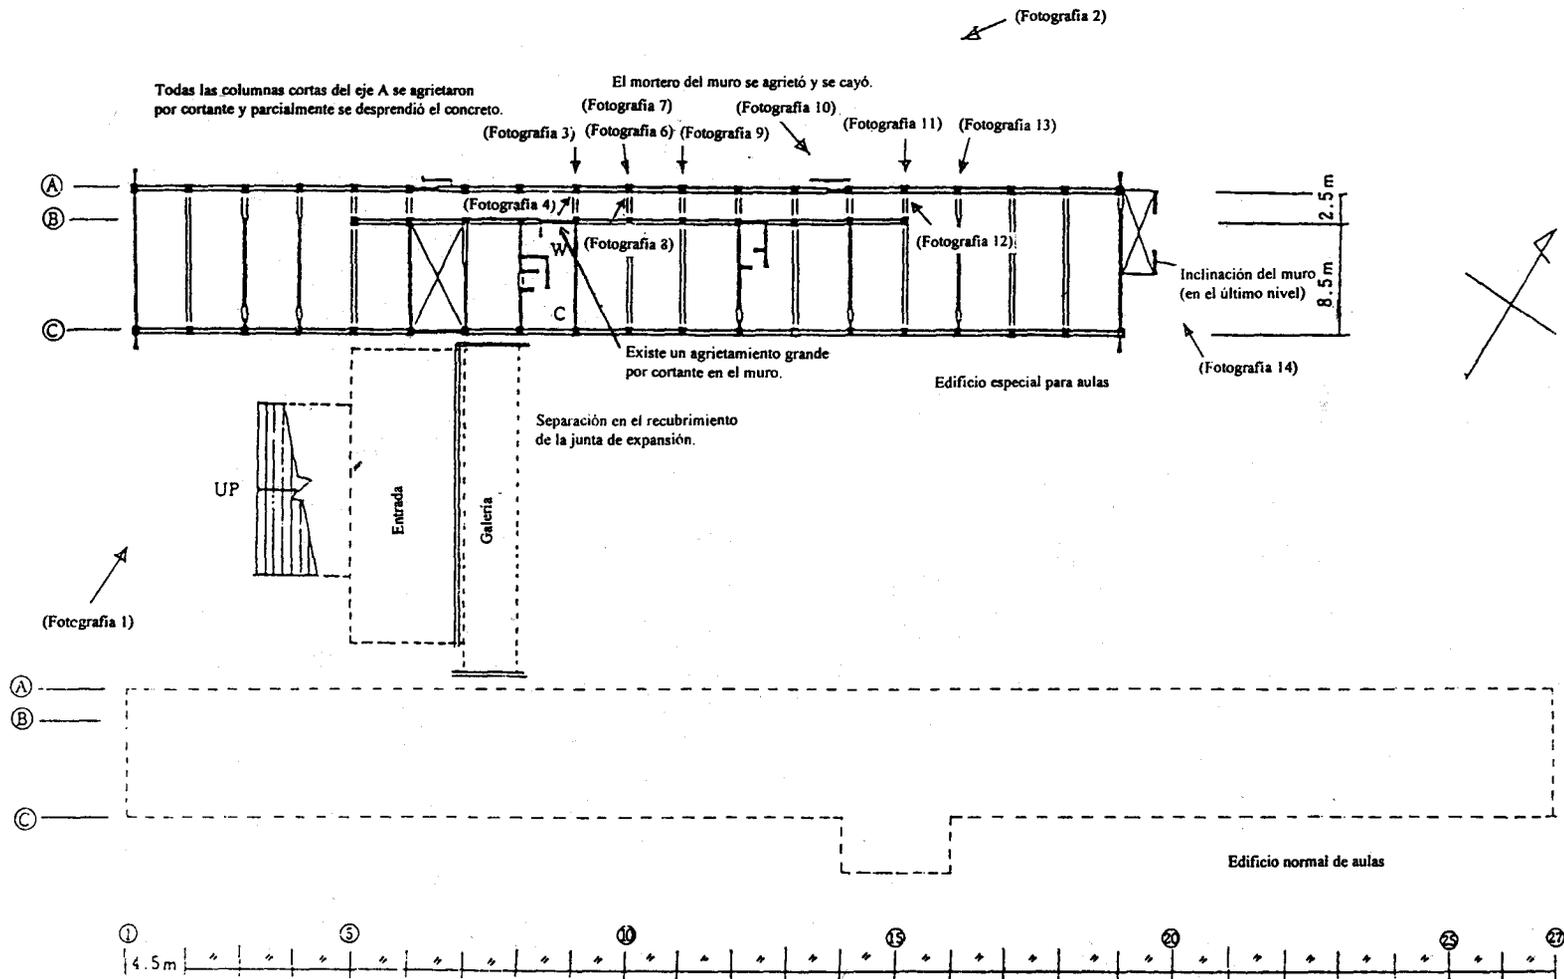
Planta del primer nivel de la preparatoria Seitou y la condición de daño
